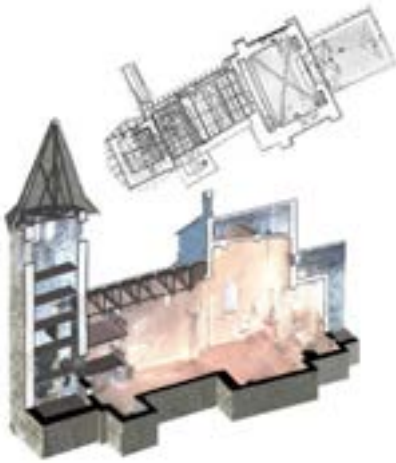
Campanau façada Oèst de Sant Pèir d'Escunhau [31]
